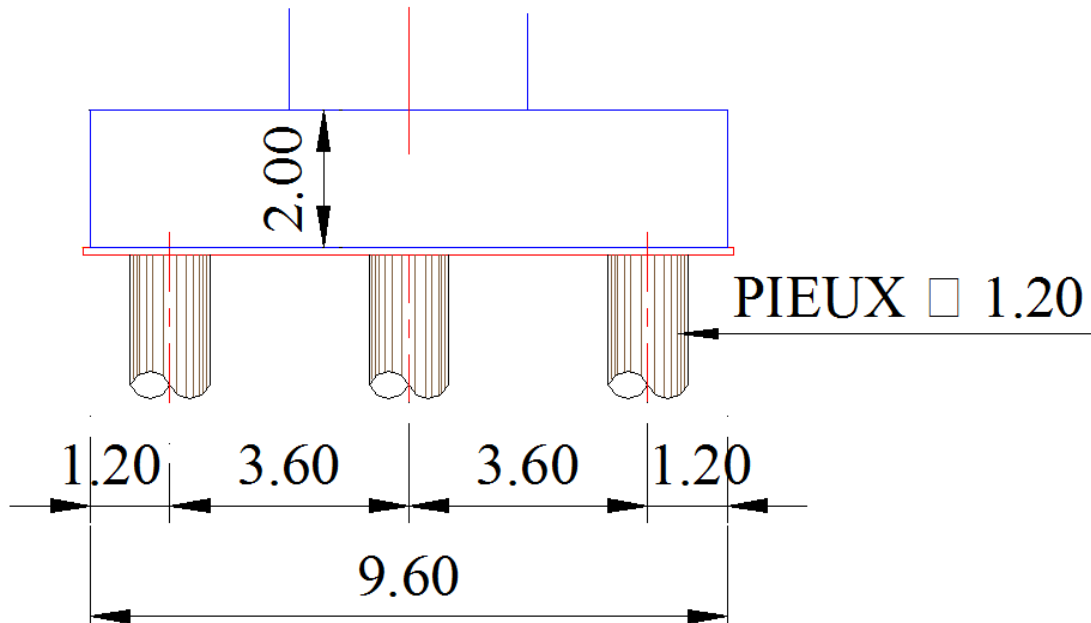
Coupe transversale (pile + semelle de liaison + pieux).
